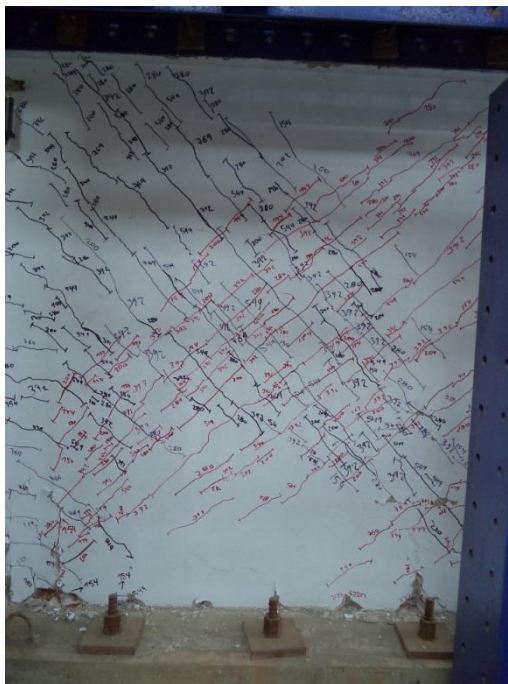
Concentración de grietas en la parte central dela cara del muro
